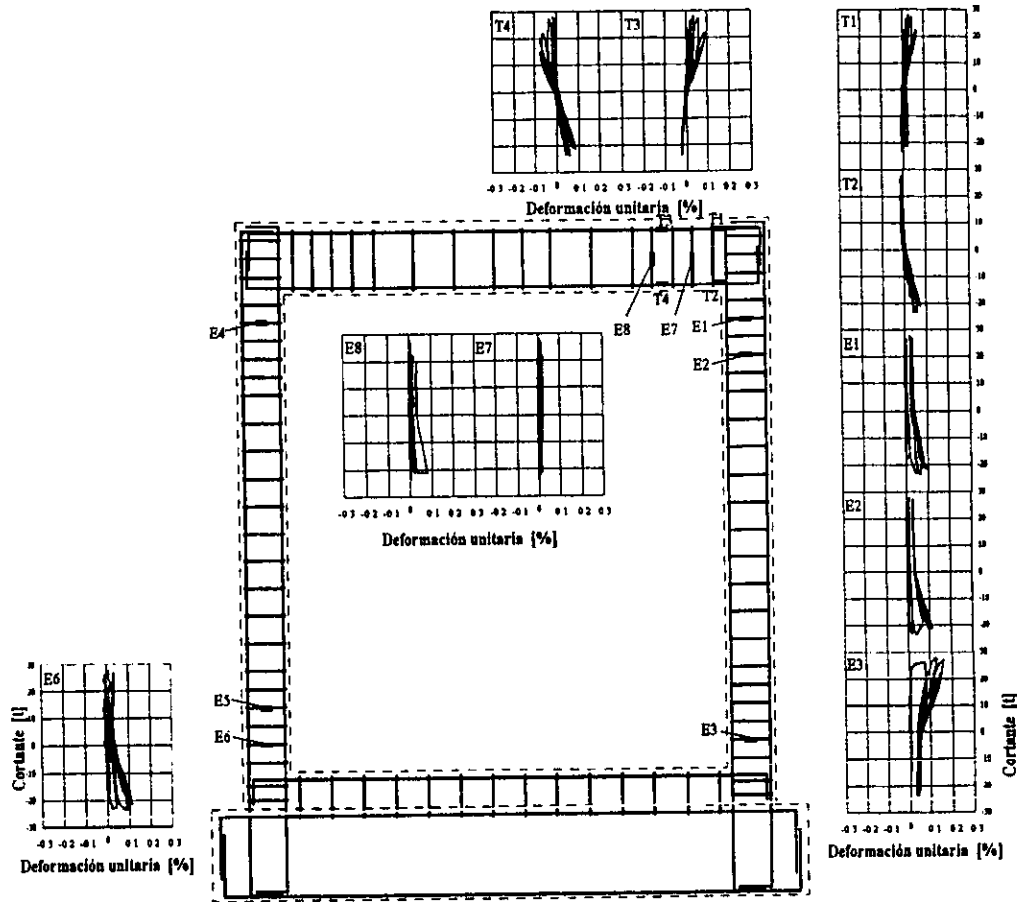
Deformímetros ubicados en el acero transversal de trabe y columnas
